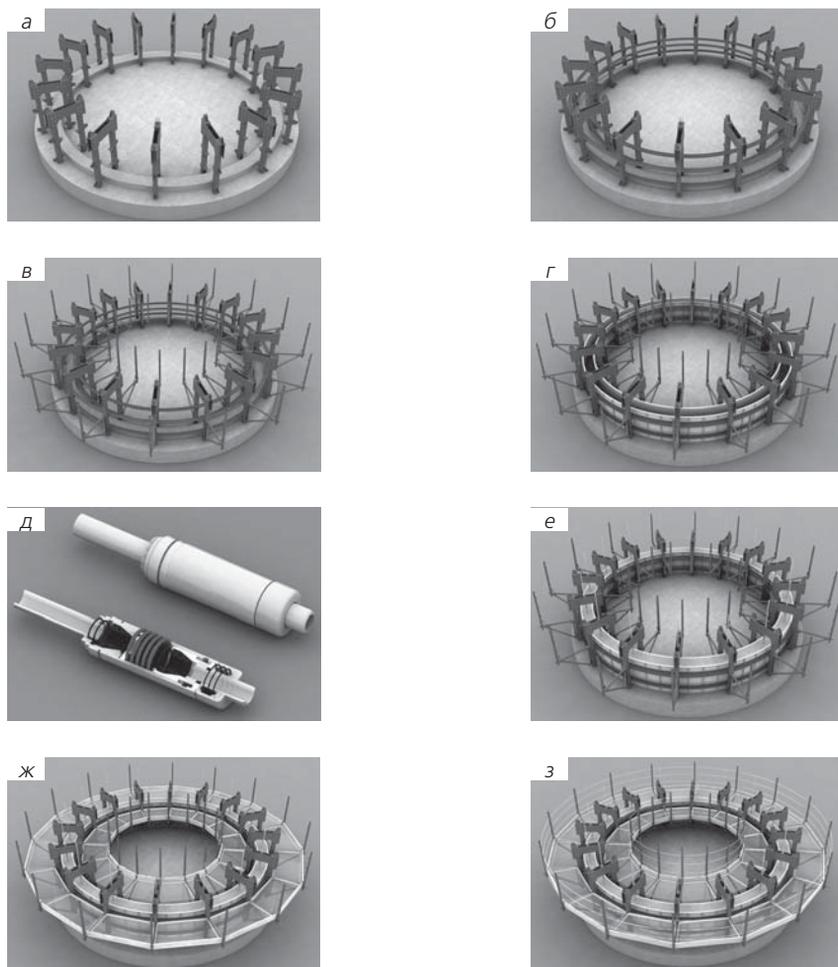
Технологическая последовательность монтажа скользящей опалубки (а – установка домкратных рам; б – фиксация элементов обрешетки (кружал); в – то же консолей для опирания верхних наружной и внутренней рабочих площадок; г – монтаж щитов скользящей опалубки; д – схема гидродомкрата; е – установка гидродомкрата на домкратную раму; ж – то же верхних наружных и внутренних рабочих площадок; з – то же перил ограждения)
